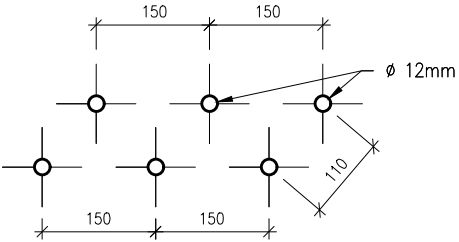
SANACE VLHKÉHO ZDIVA
